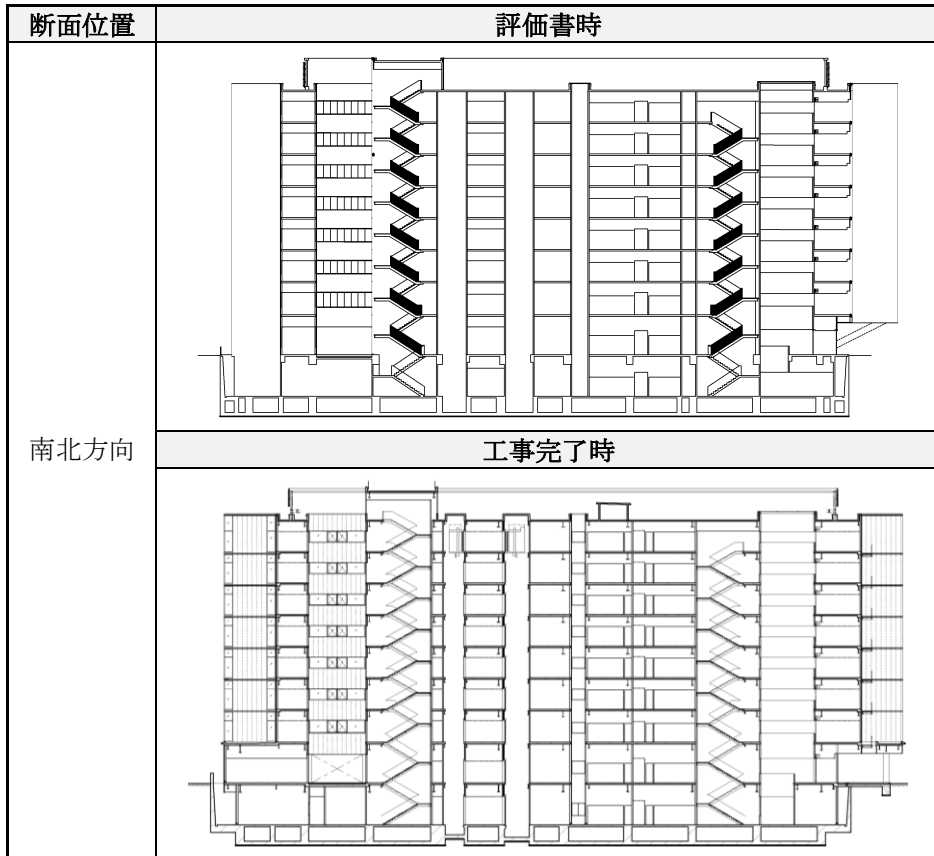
(2) 研究棟断面図 (南北方向) (2/2)
